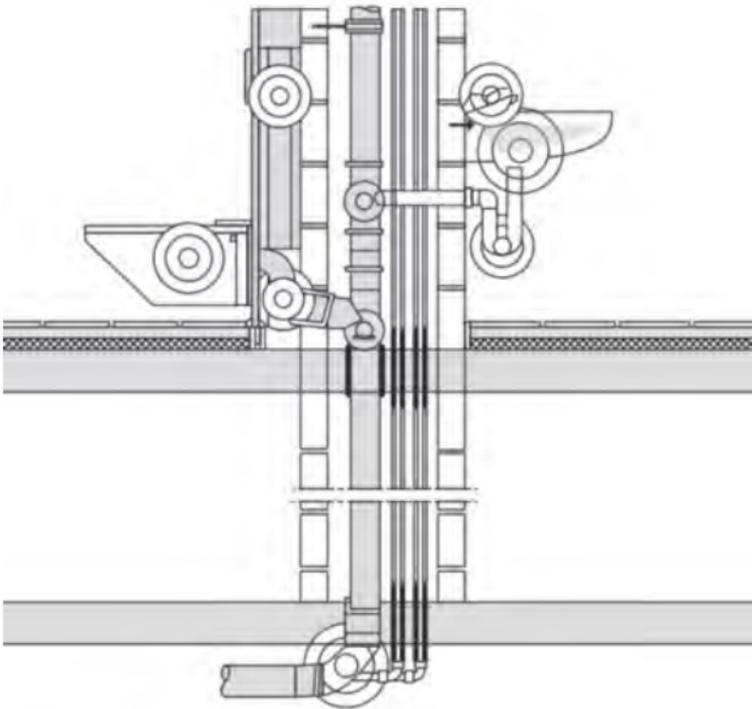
Montagedetail Anschlussfuge (Quelle: Henrich)
